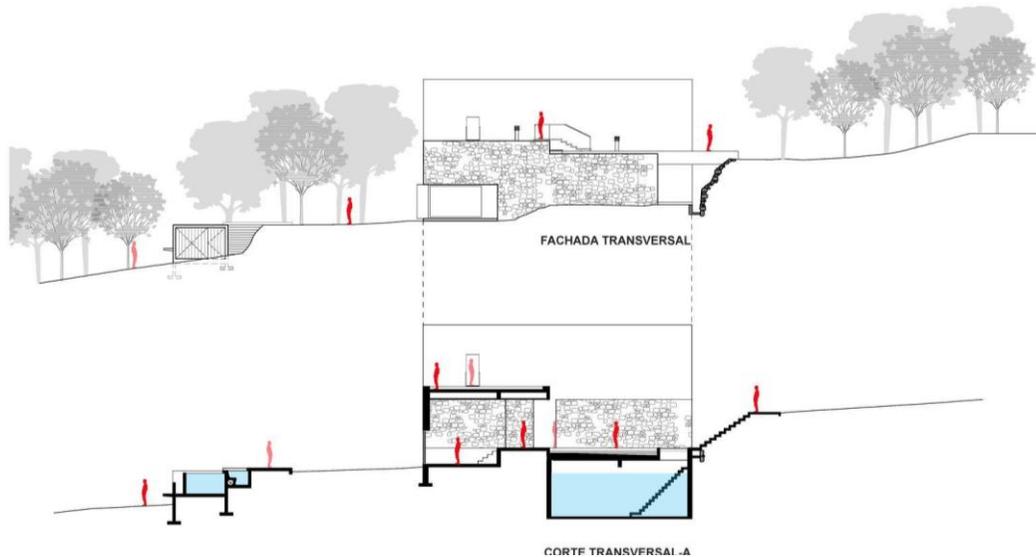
Sección Casa Meztitla. 2017. Plataforma arquitectura.
